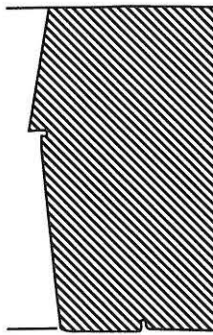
Gewändeprofilierung im Grundriss von Fenster (207.7). M 1:20.
